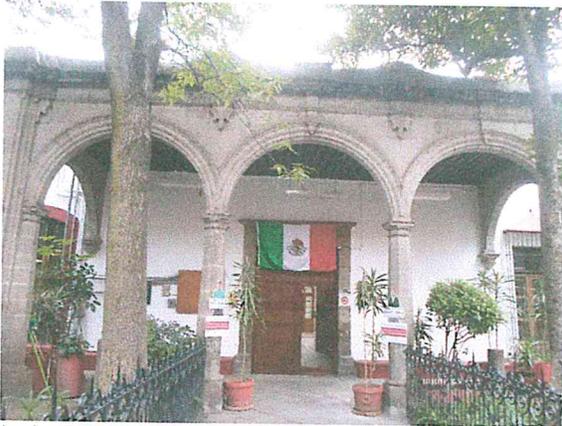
Fachada y acceso al PRIMER INMUEBLE (Dir. Protección Infancia), sin afectaciones estructurales.
